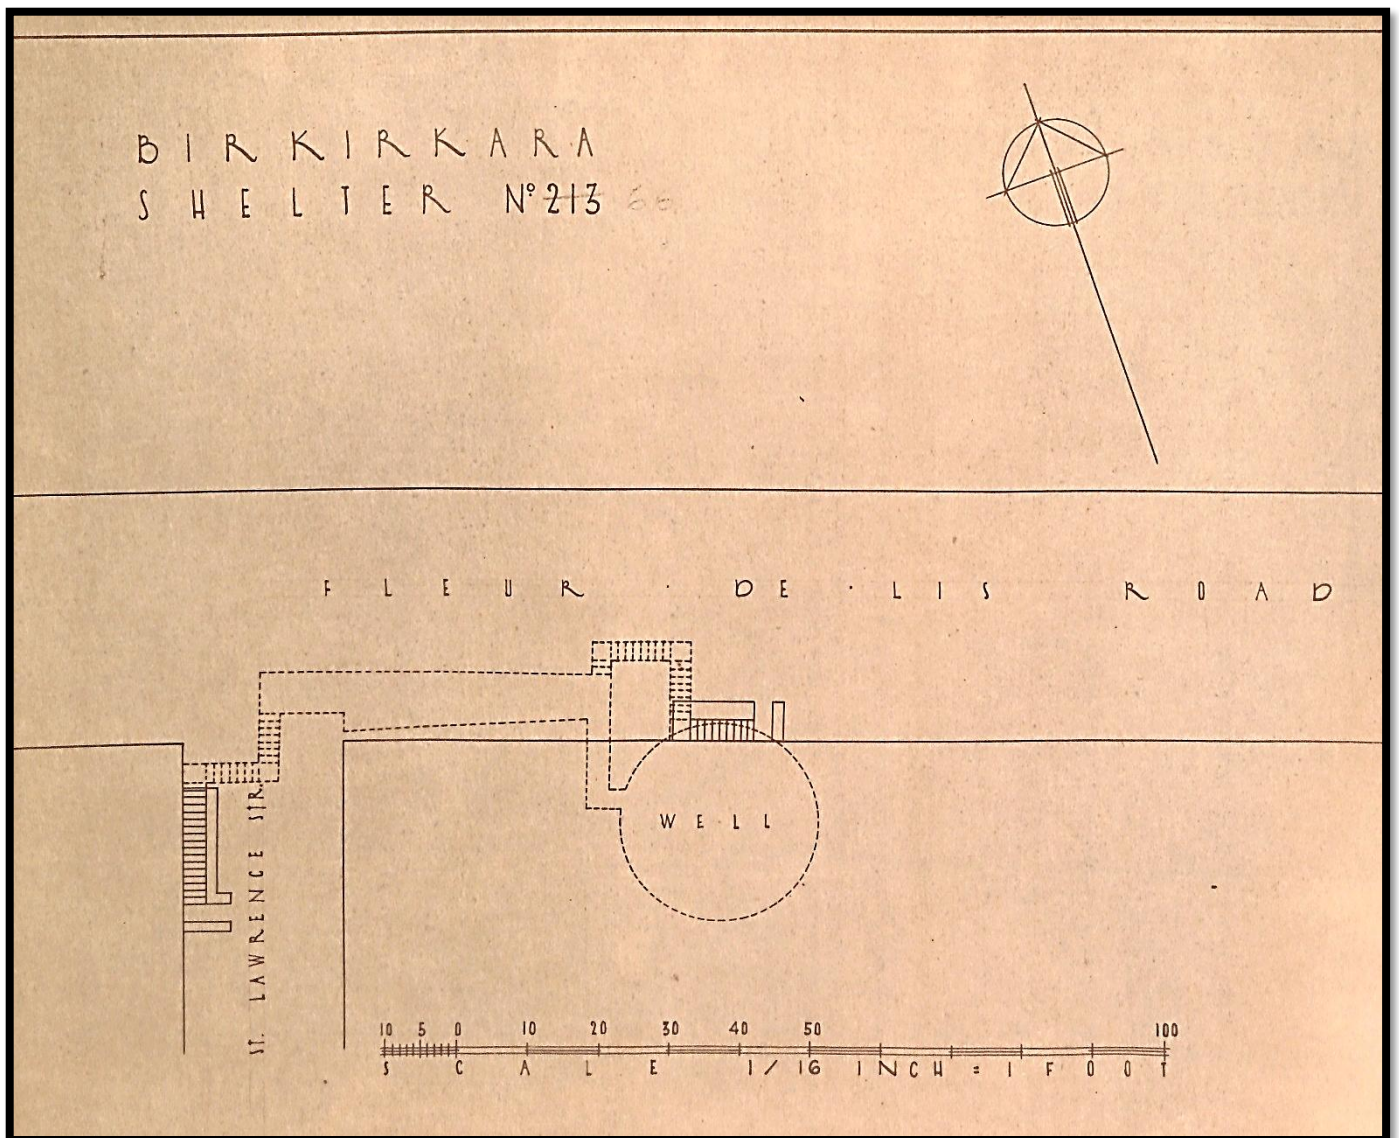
Planta do Abrigo nº 213 (66) "St. Laurence Str. – Fleur – de – Lis Road"
